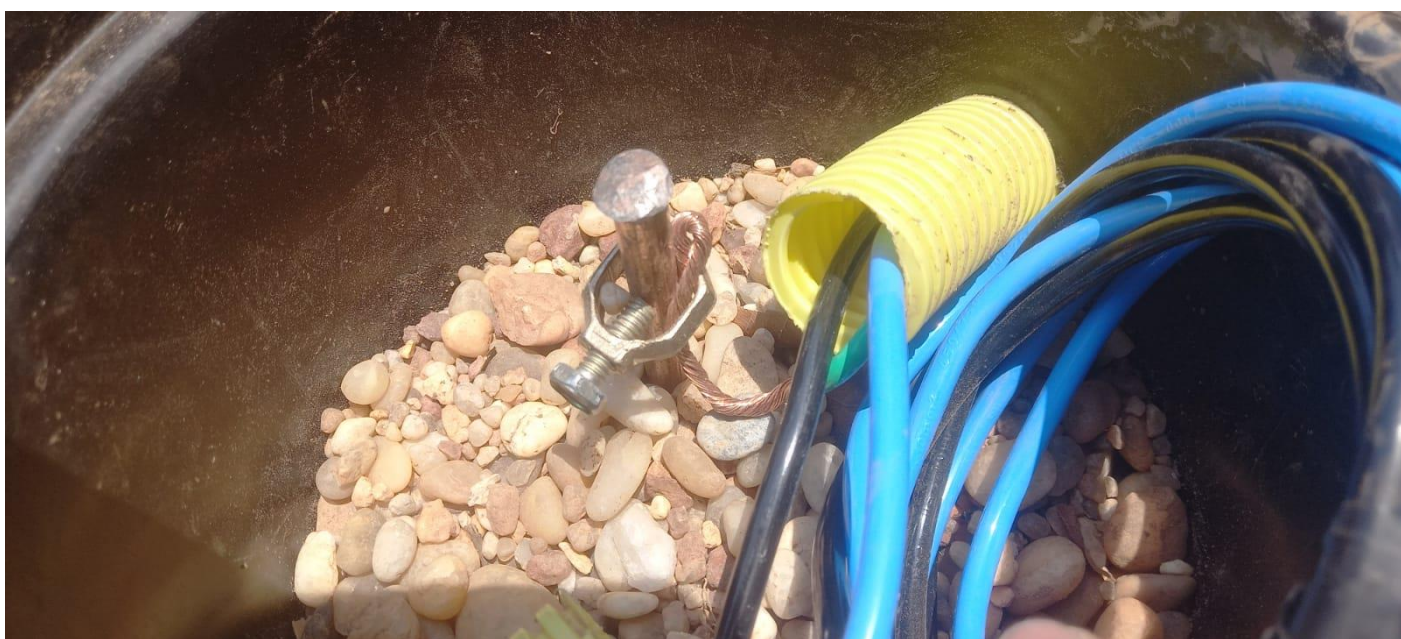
HASTE DE ATERRAMENTO 3/8" 2 M DE COMPRIMENTO E CONECTOR TIPO GRAMPO. DENTRO DA CAIXA DE PASSAGEM PVC.
